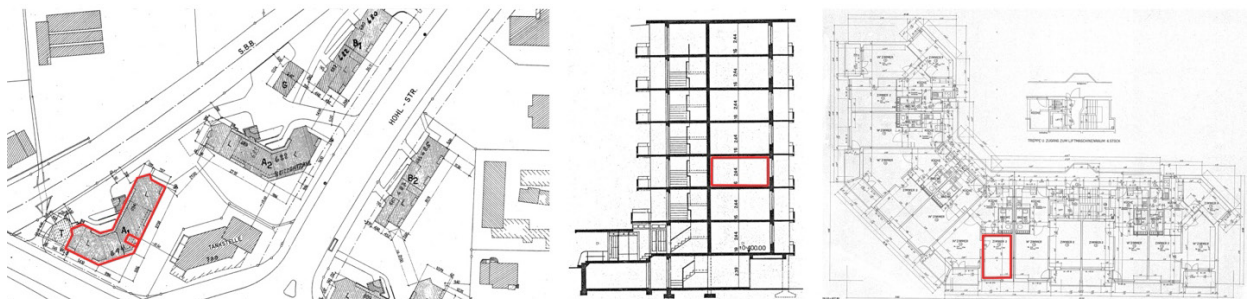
Verortung Modellzimmer mit Stahlbetondecke, Quelle: Stadt Zürich, AHB.
